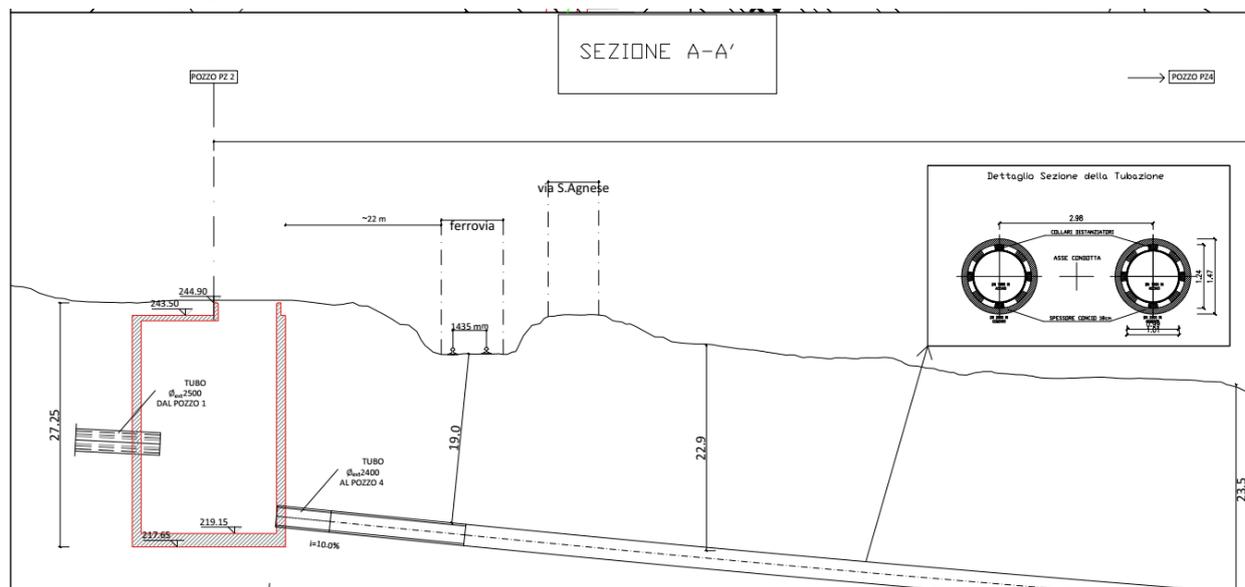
dettaglio dell' attraversamento della ferrovia RM-PE
